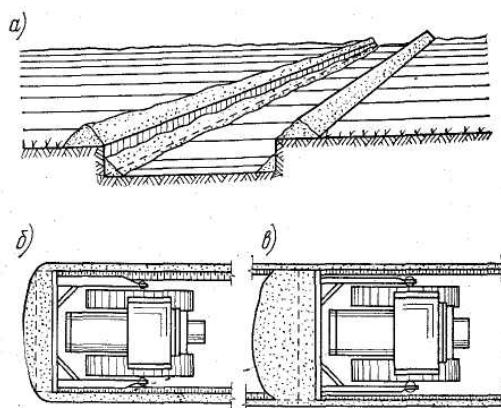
Траншейный способ разработки и перемещения грунта бульдозером:
